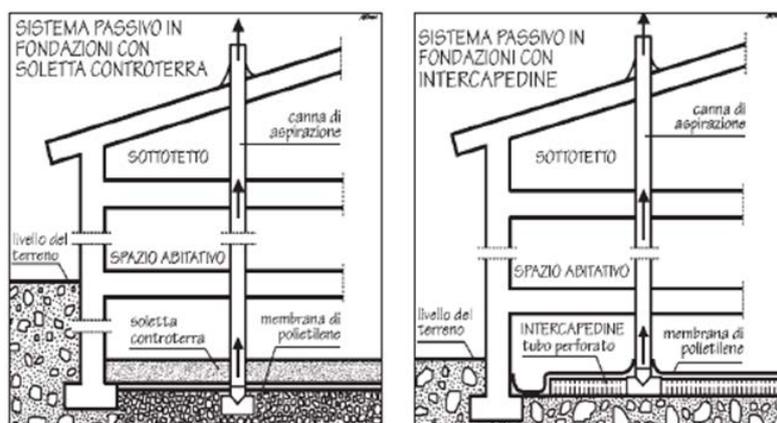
Sistema passivo in fondazioni con soletta controterra; Fig 2 – Sistema passivo in fondazione con intercapedine.
